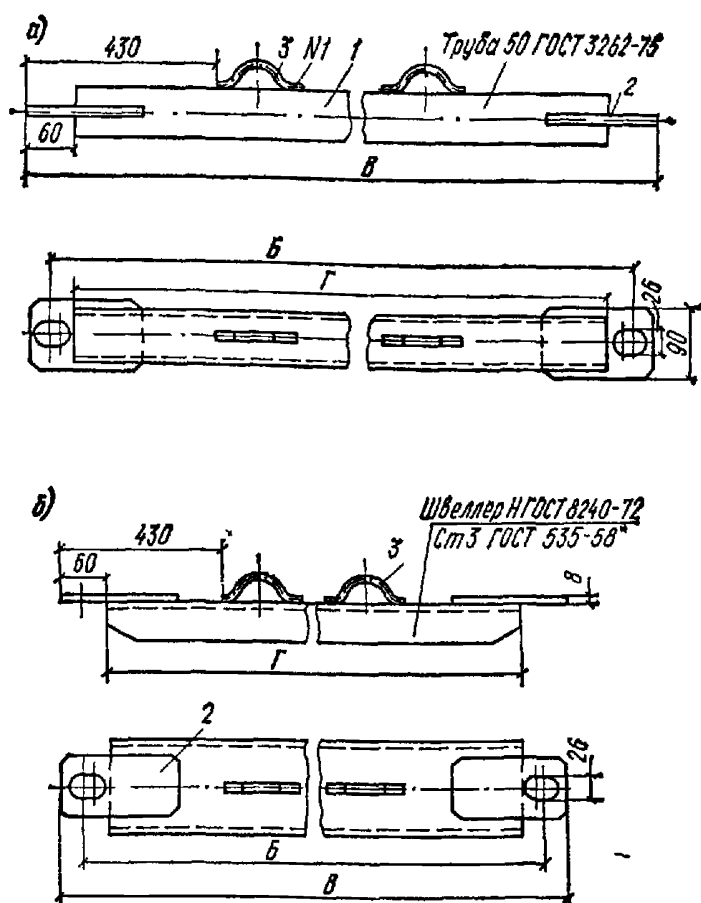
Стяжки для рельсовых путей с железобетонными балками
